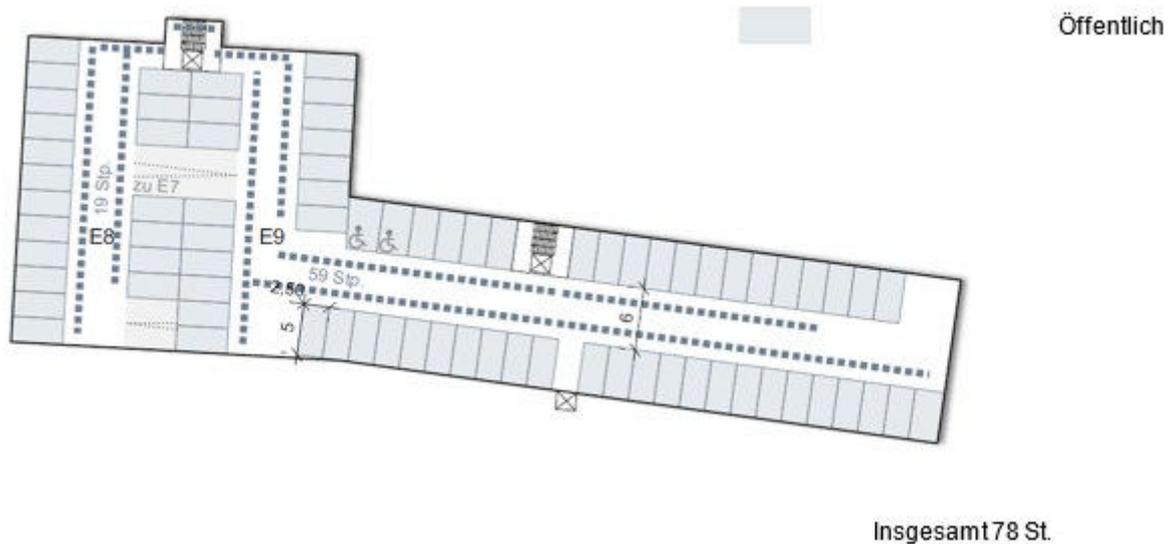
Funktionsgrundriss Parkhaus Ebene E8-E9 (o.M.)
